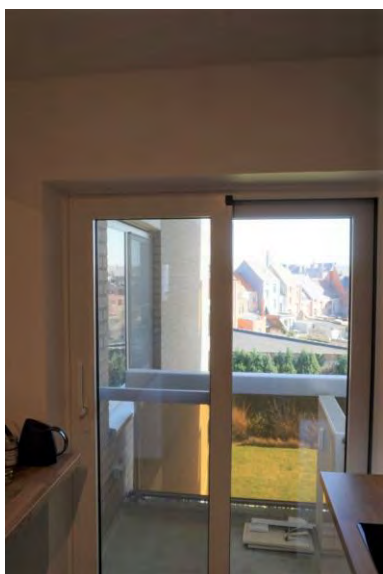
Vloeibare waterdichting op terras – beperkte opstand
